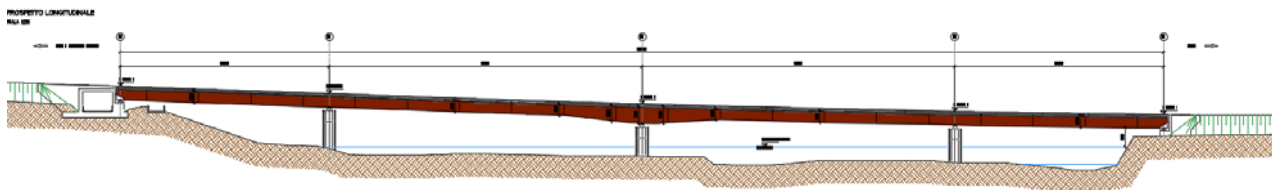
Sezione longitudinale viadotto sull'Ellero (Estratto dalla tavola di progetto P00VI01STRPF01_A)
